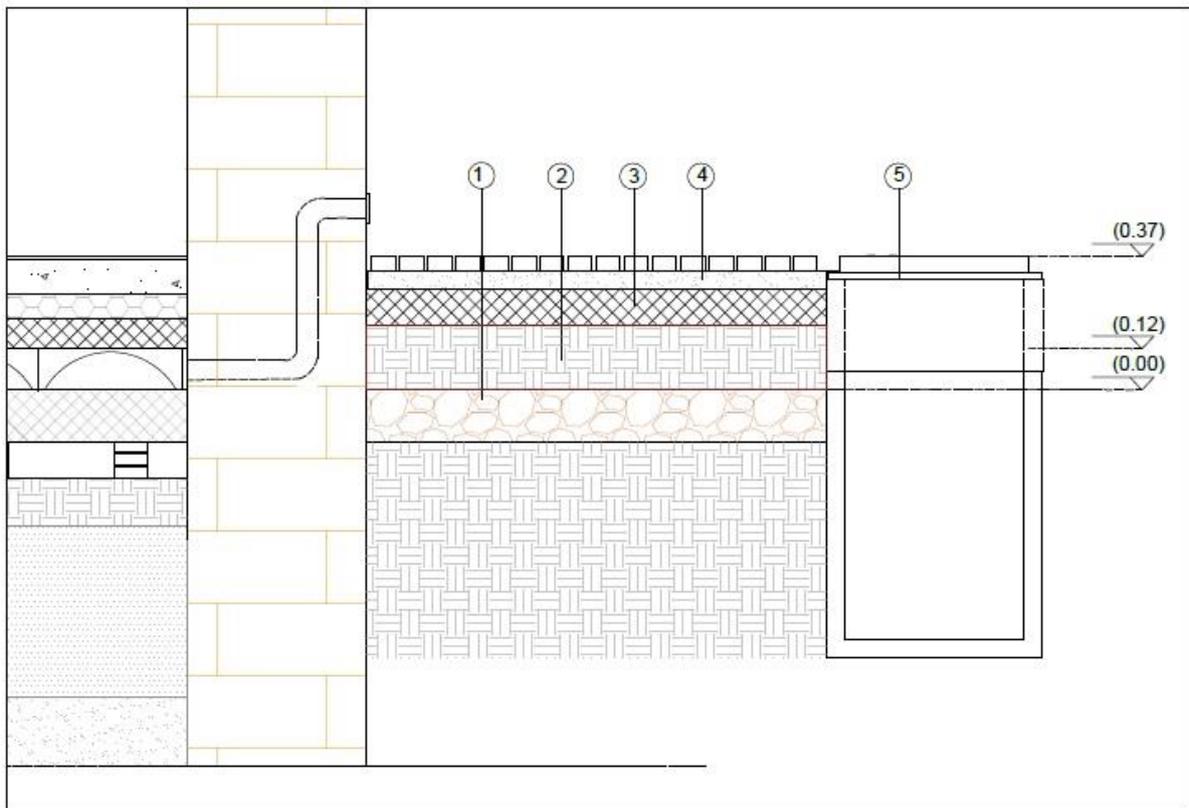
Progetto architettonico edificio A – Dettaglio di progetto corte interna e solaio interno al piano terra
